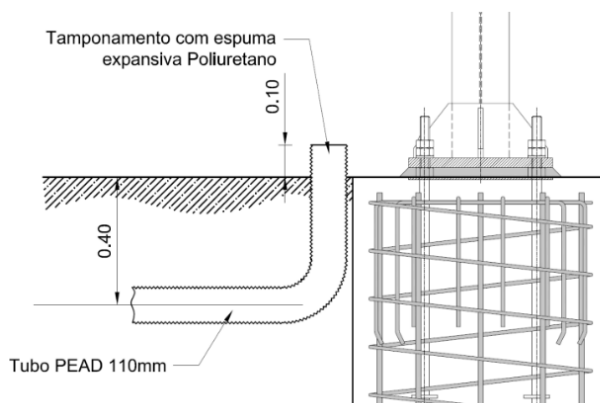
Tubo PEAD 110 mm para passagem de cabos de energia entre o poste e a caixa de inspeção
